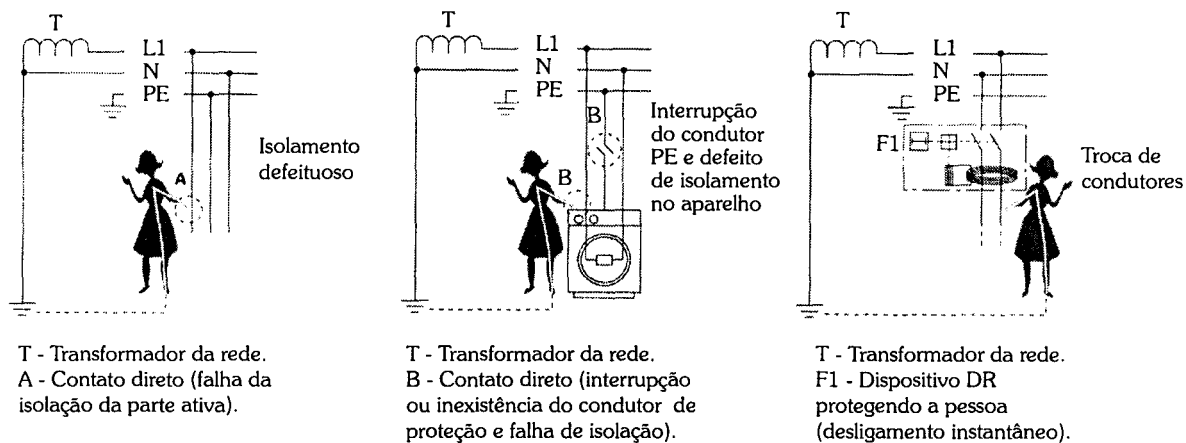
Exemplos de contatos diretos com partes ativas da instalação. Cortesia: Siemens.
